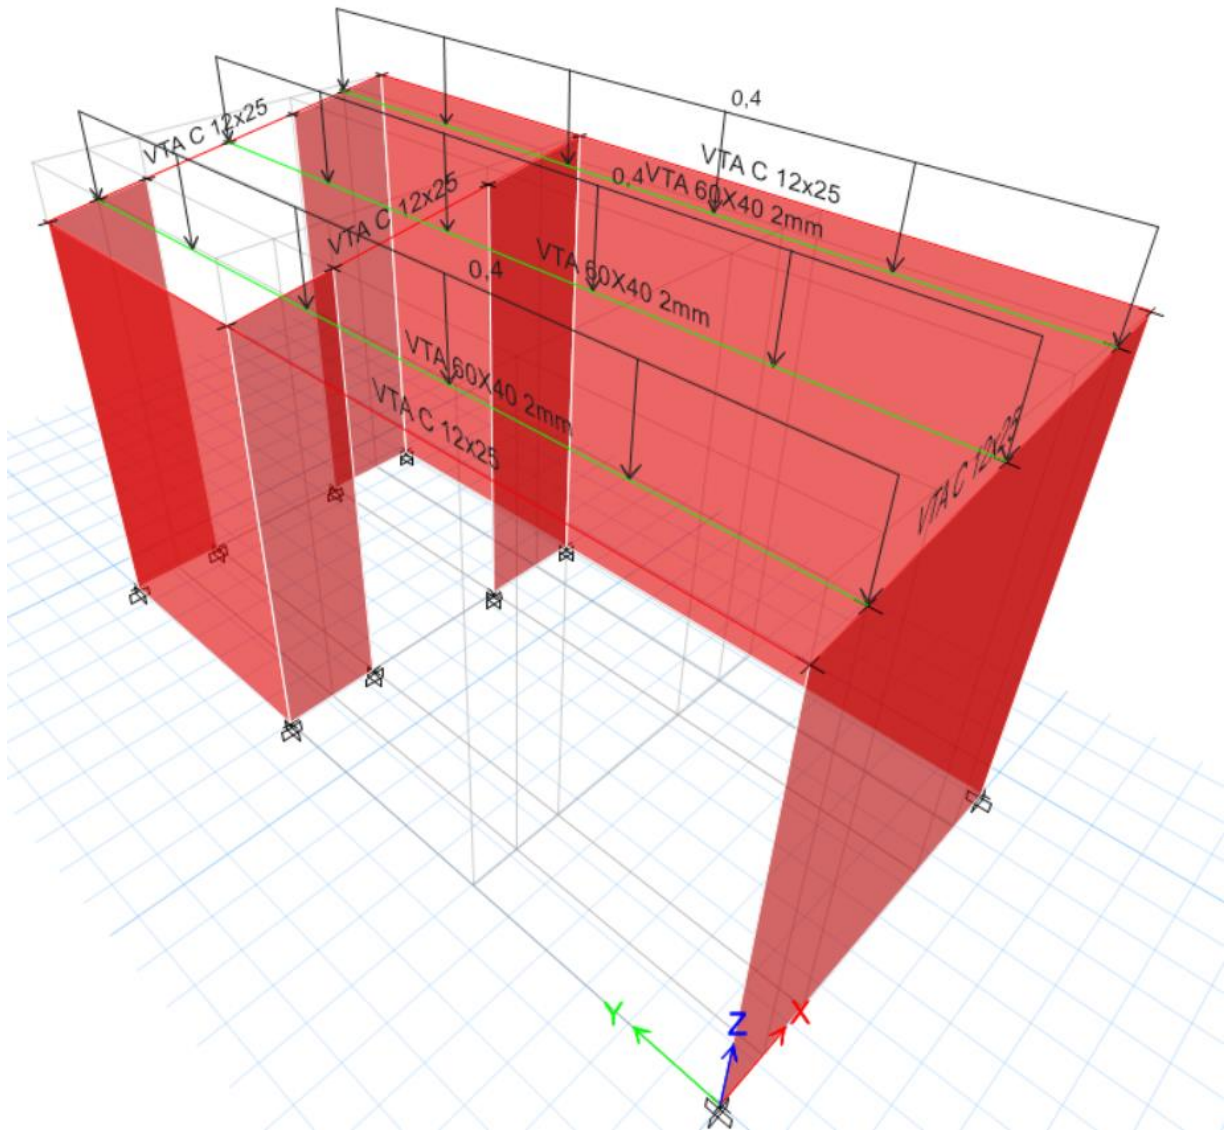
Carga Viento distribuida (W) [kN, m, C]
